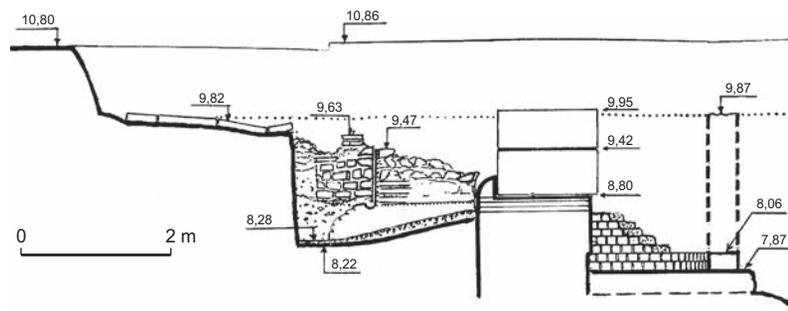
Coupe des structures contre le mur nord de la basilique (plan J.-L. Paillet et J. Schreyeck, CNRS).
